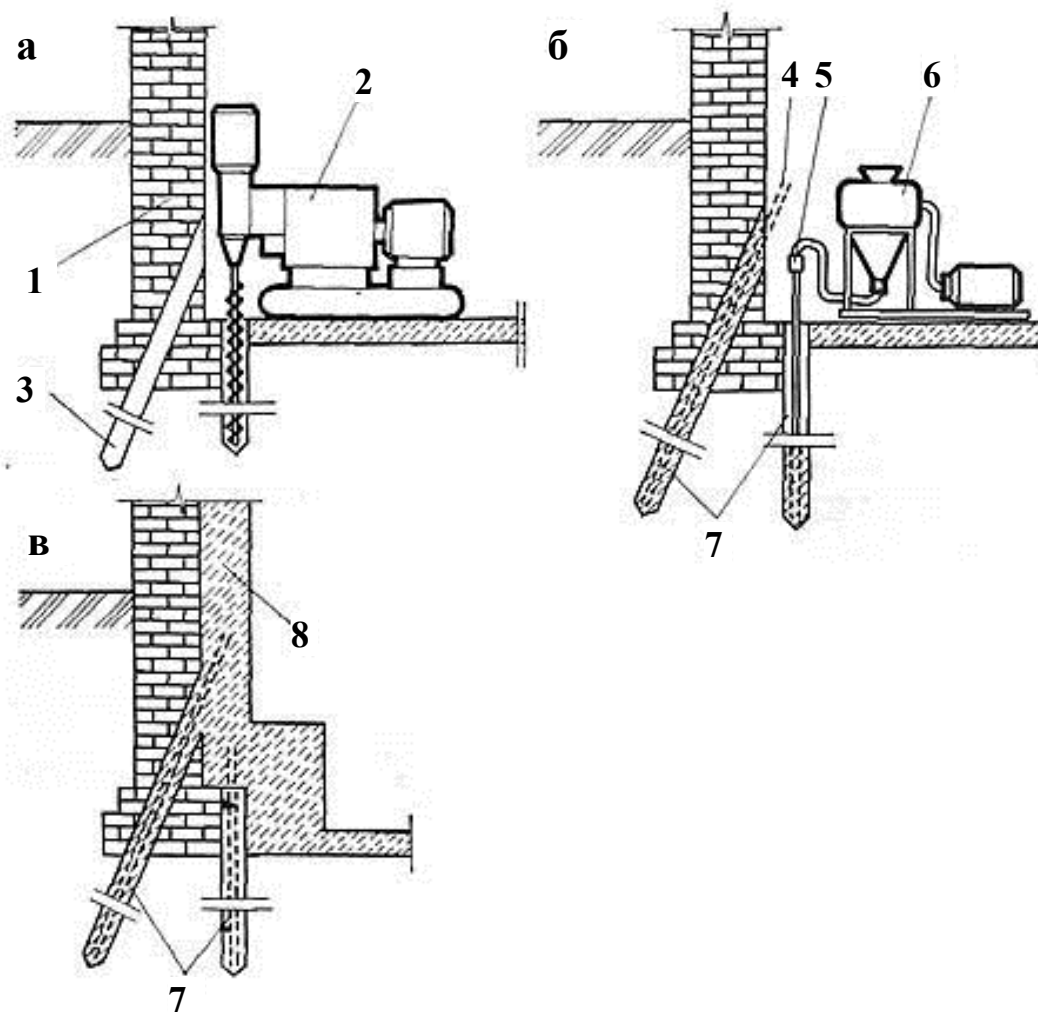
Схема підсилення фундаментів бурін'єкційними паями: а – буріння свердловин; б – установлення арматури і ін'єктування дрібнозернистої бетонної суміші; в – улаштування залізобетонного ростверку; 1 – стіна будівлі; 2 – буровий верстат; 3 – свердловина; 4 – випускання арматури для сполучення палі з ростверком; 5 – ін'єктор; 6 – пневматична ін'єкційна установка; 7 – бурін'єкційні пая; 8 – залізобетонний ростверк
